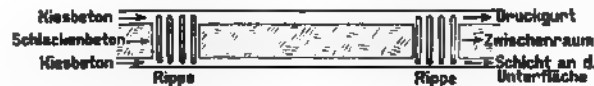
Querschnitt einer kombinierten Massivdecke, System Ed. Züblin.
